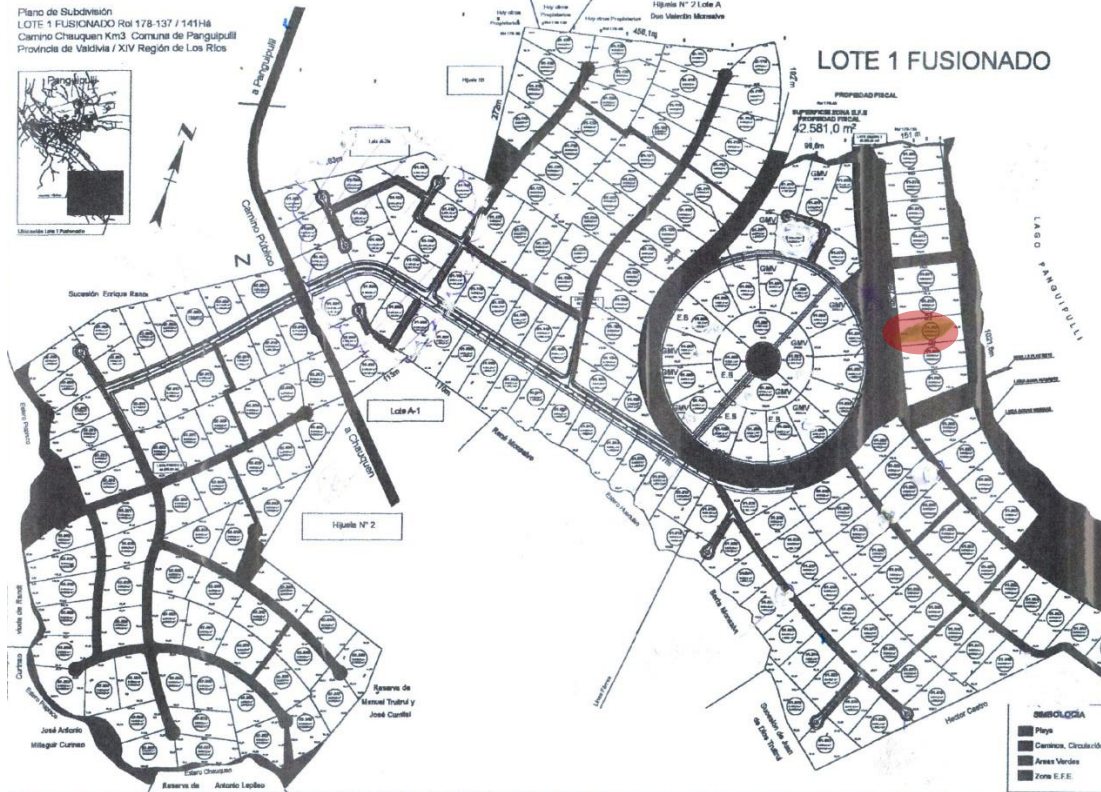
Plano general del proyecto de loteo y ubicación señalada para el
